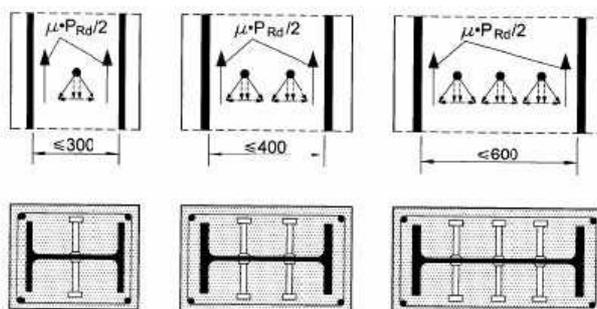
Disposizione dei pioli per la connessione meccanica acciaio-calcestruzzo
